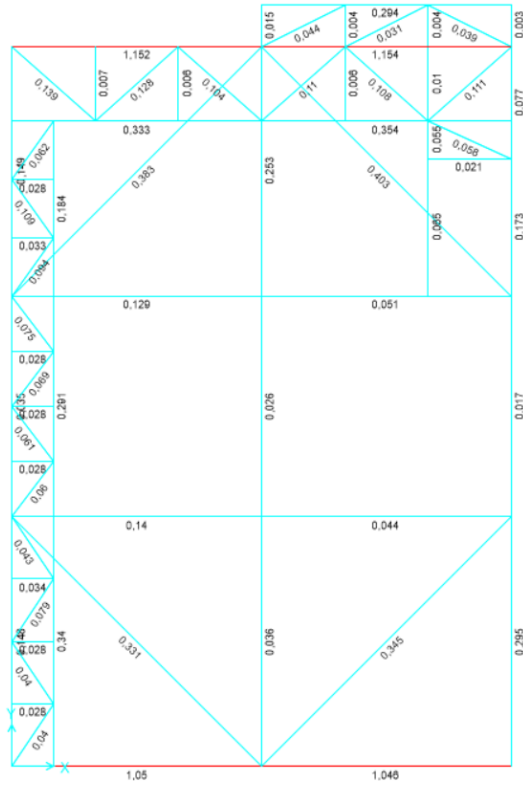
Factores de utilización vista en planta elevación 4.8 m.
